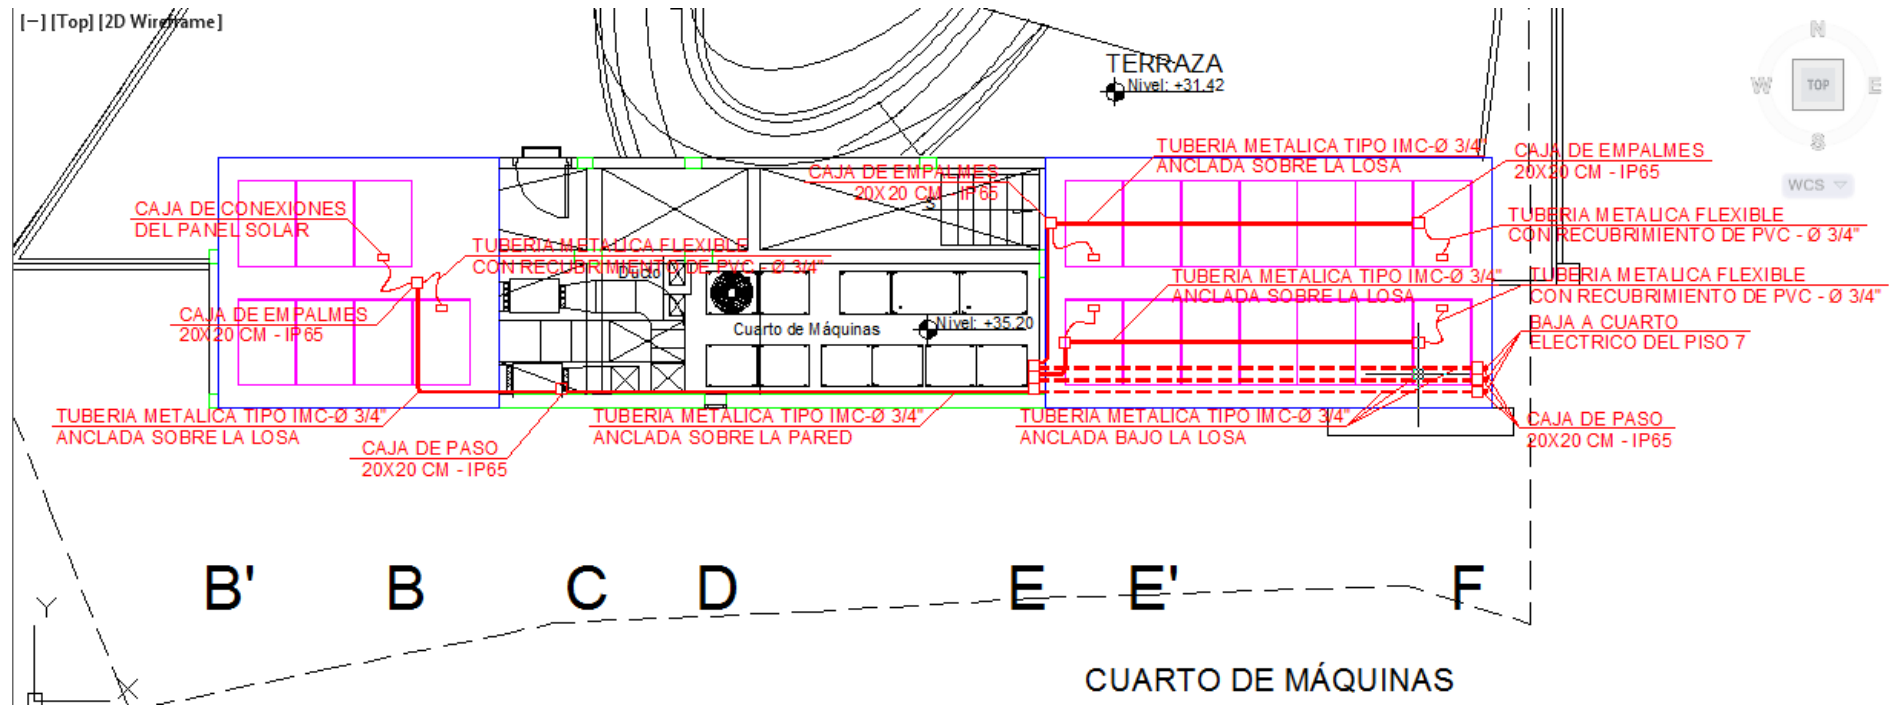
Distribución de tuberías de corriente continua en la losa
